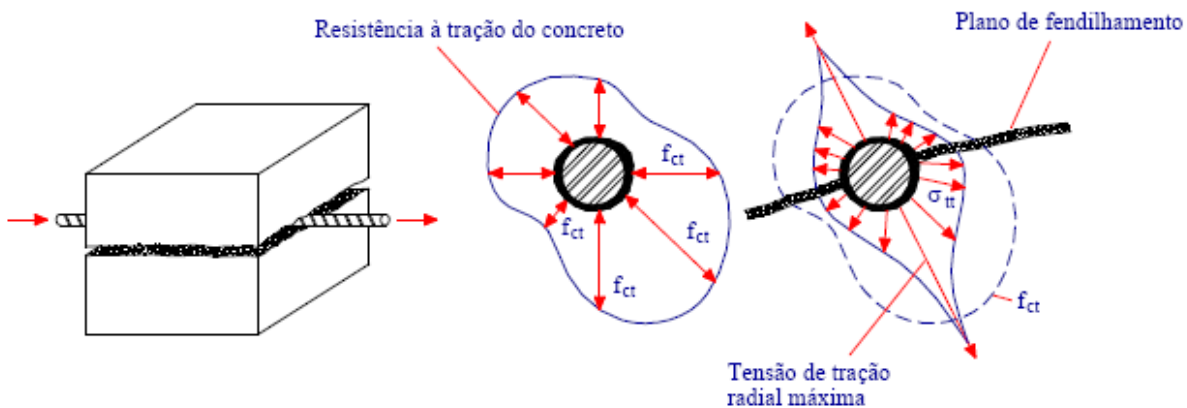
Fendilhamento longitudinal do concreto (FUSCO, 1995)
